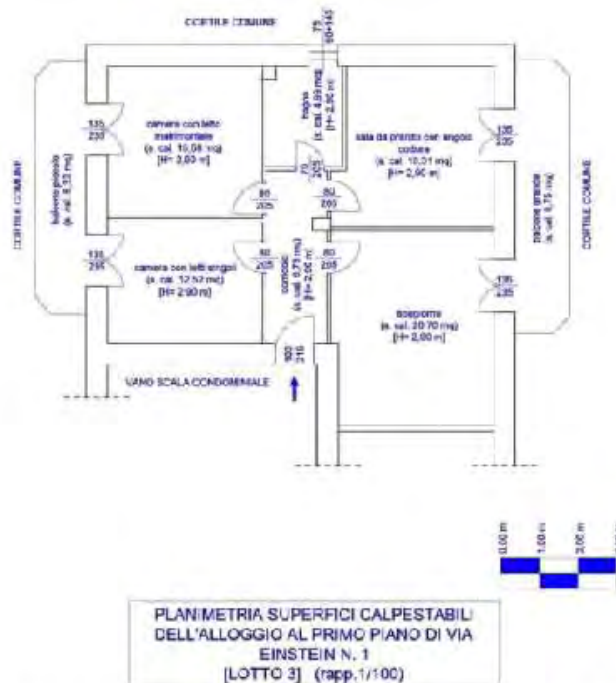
Planimetria urbanistica alloggio al primo piano (26.6.2018)
